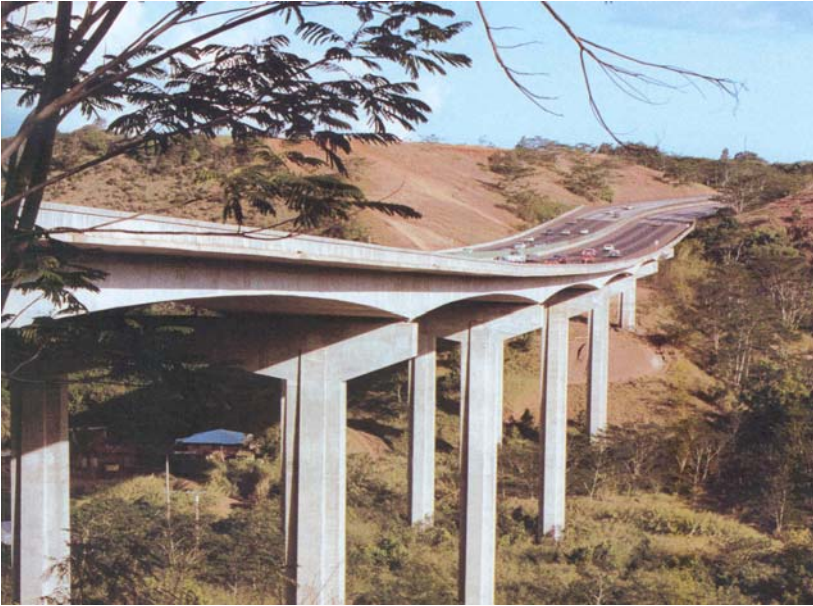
Kipapa Stream Bridge, Oahu, Hawaii
